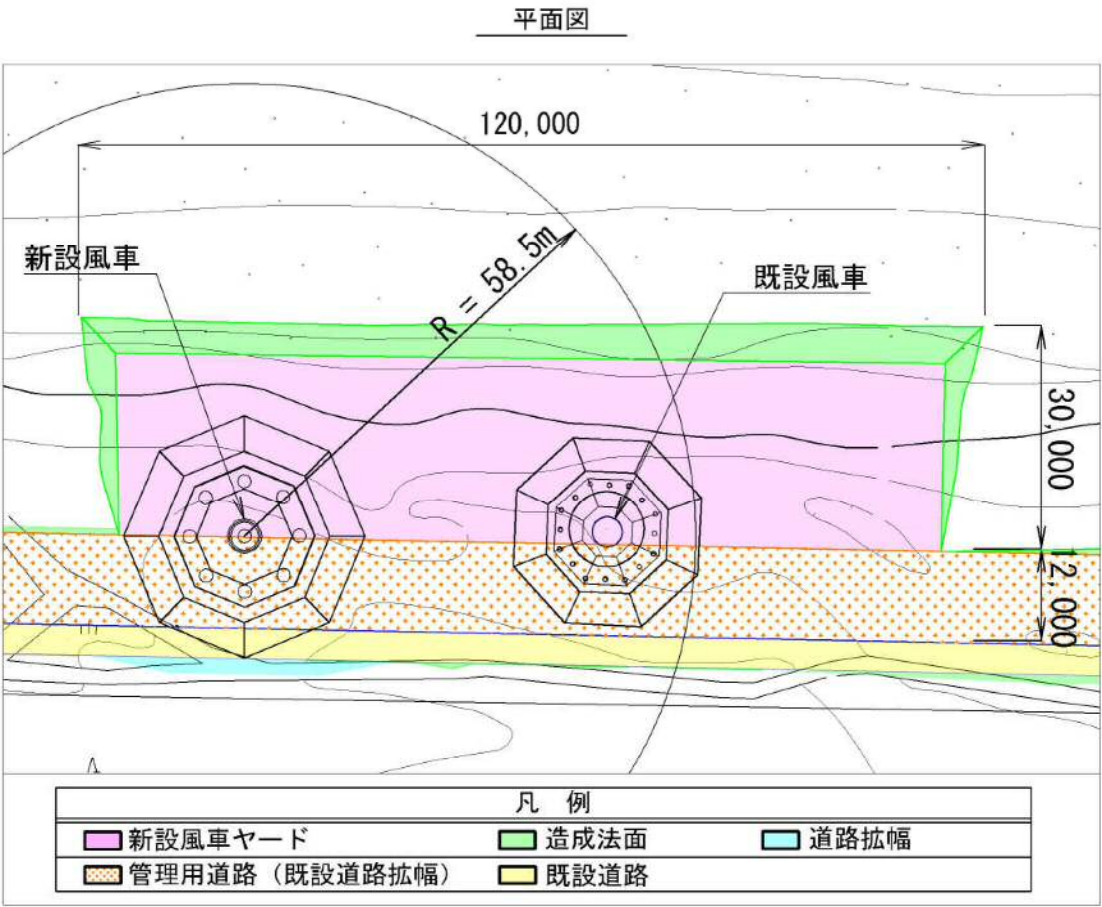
(3) 造成平面・横断計画図 (新設 3 号機)
